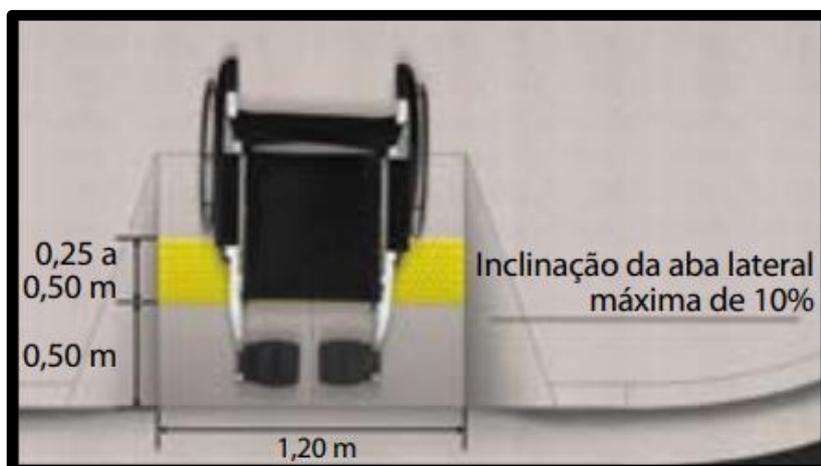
Parâmetro de rampa de acesso (Fonte: Guia Prático para Construção de Calçadas)
